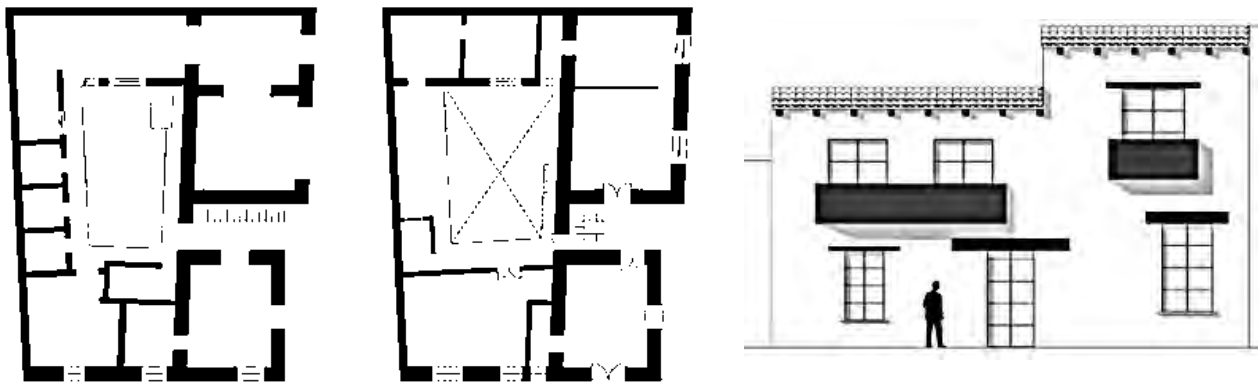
Planta arquitectónica y alzado de Inmueble restaurado e integrado por despacho de arquitectura EMA. Fuente: <http://www.espacioema.com/estudio/> [Fecha de consulta 30 de julio de 2013].
